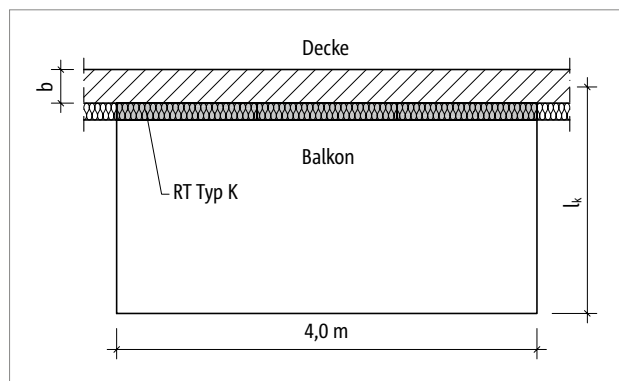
Schöck Isokorb® RT Typ K: Grundriss
